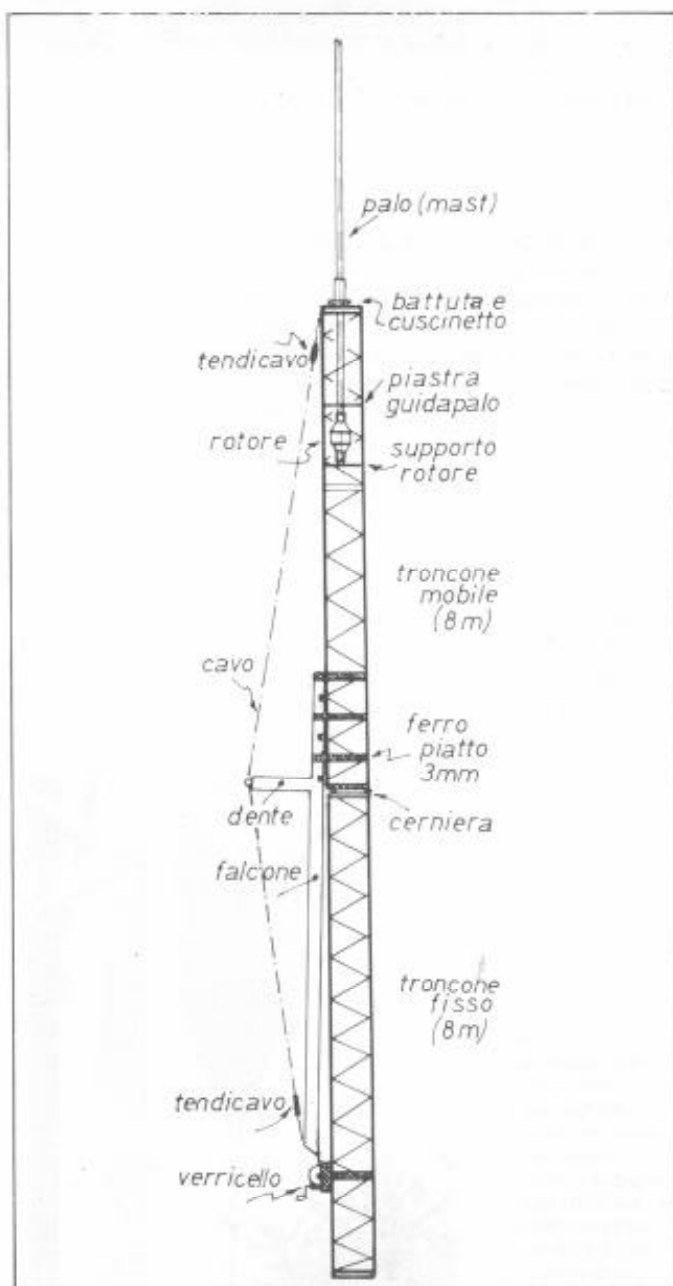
Schema del traliccio. Si noti la posizione del falcione.
